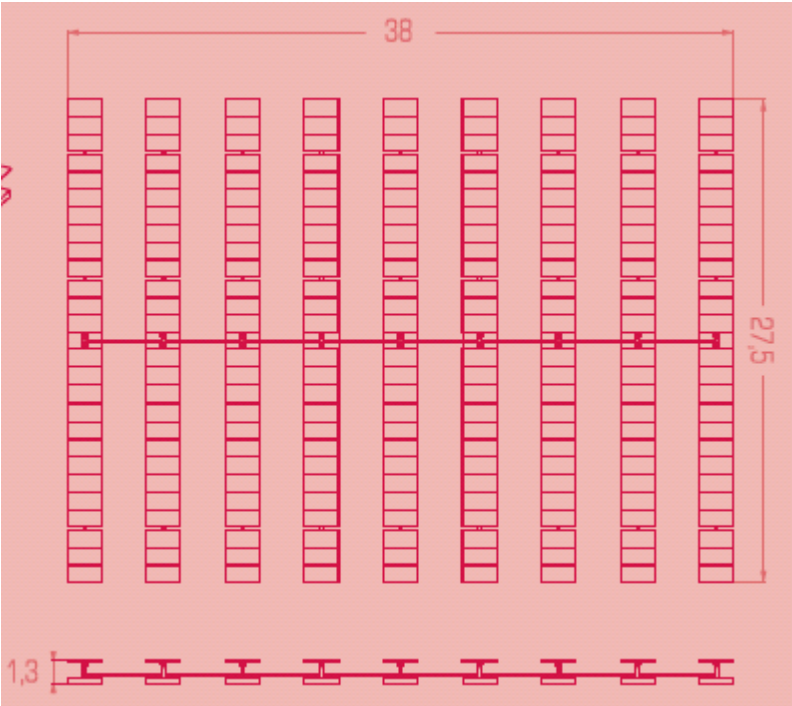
Vista en planta y alzado de una distribución de huerto solar, con paneles en horizontal, empleando el sistema SA 60.
